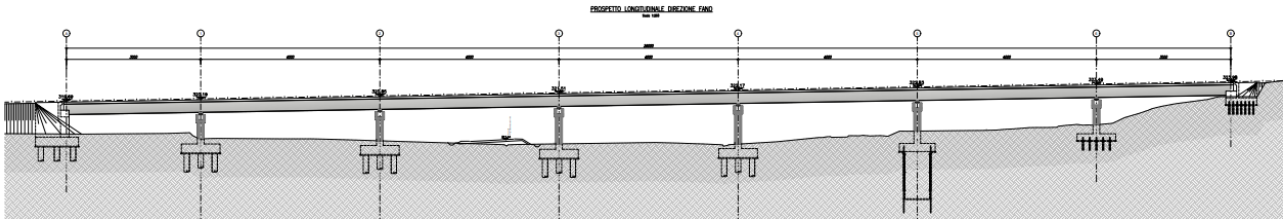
Profilo longitudinale carreggiata direzione Fano.
